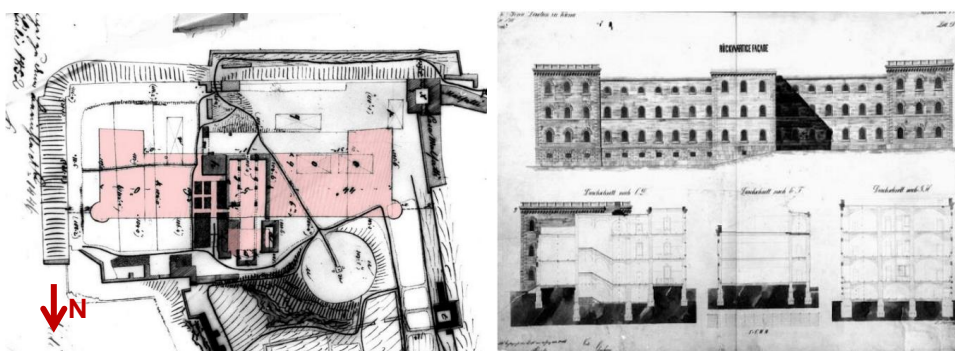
"Situations Plan des Castelles S. Pietro" (1852), Kriegsarchiv, Wien
